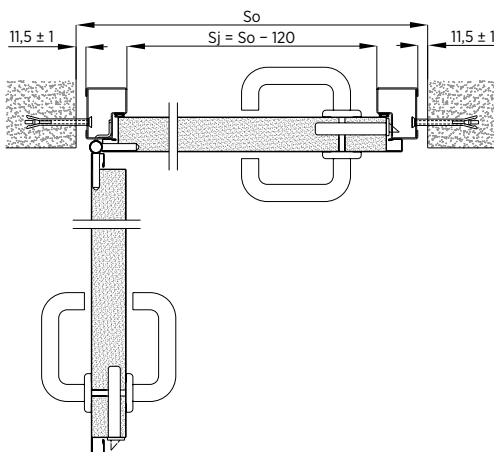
Montage d'un bloc-porte à un battant avec bâti intérieur - coupe horizontale
